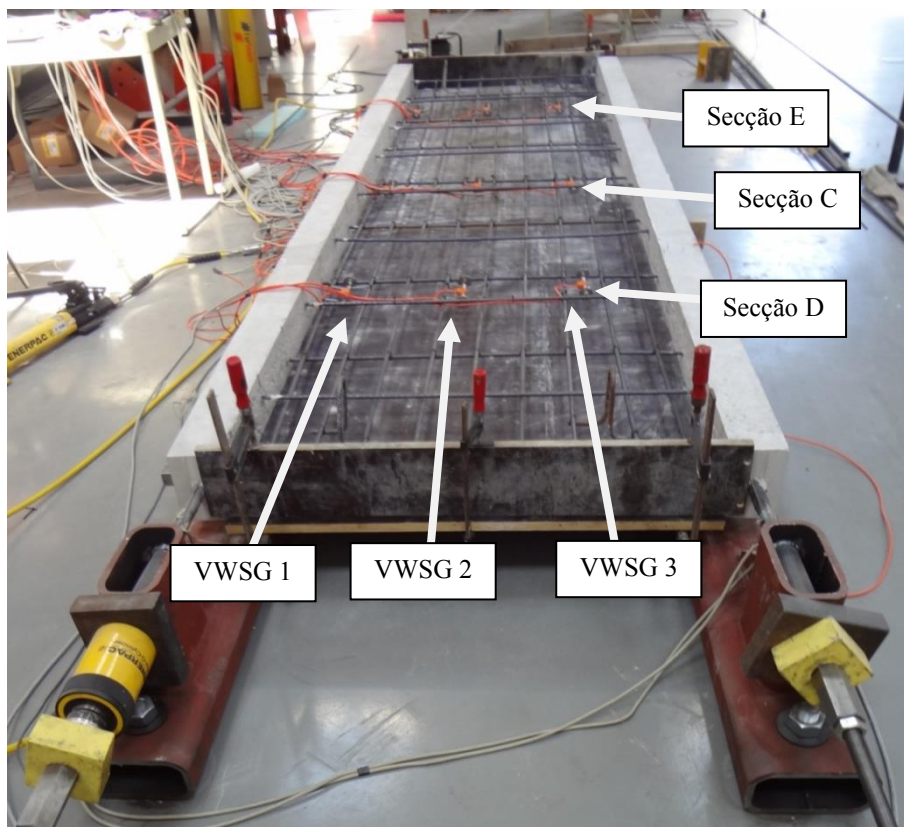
Identificação dos VWSG instaladas na estrutura laminar.
